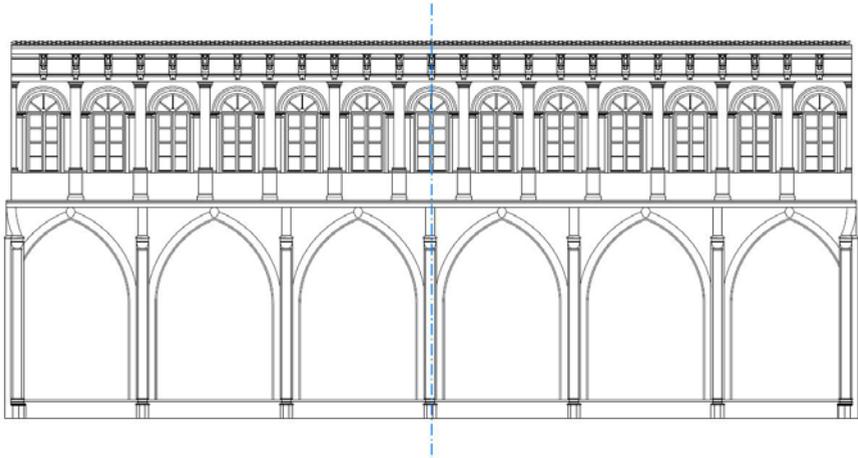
Alzado Sur del Claustro Mayor. 2016. Plano del autor.
